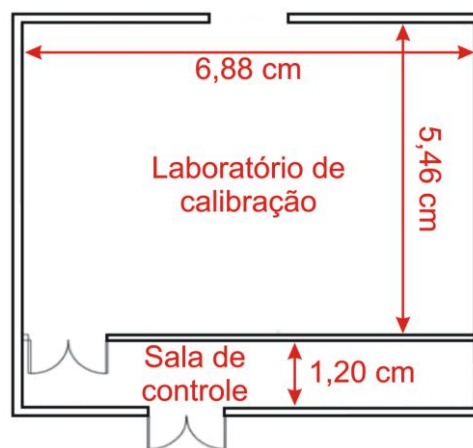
Planta baixa das futuras instalações do Laboratório de Calibração de Nêutrons do IPEN/CNEN-SP.
